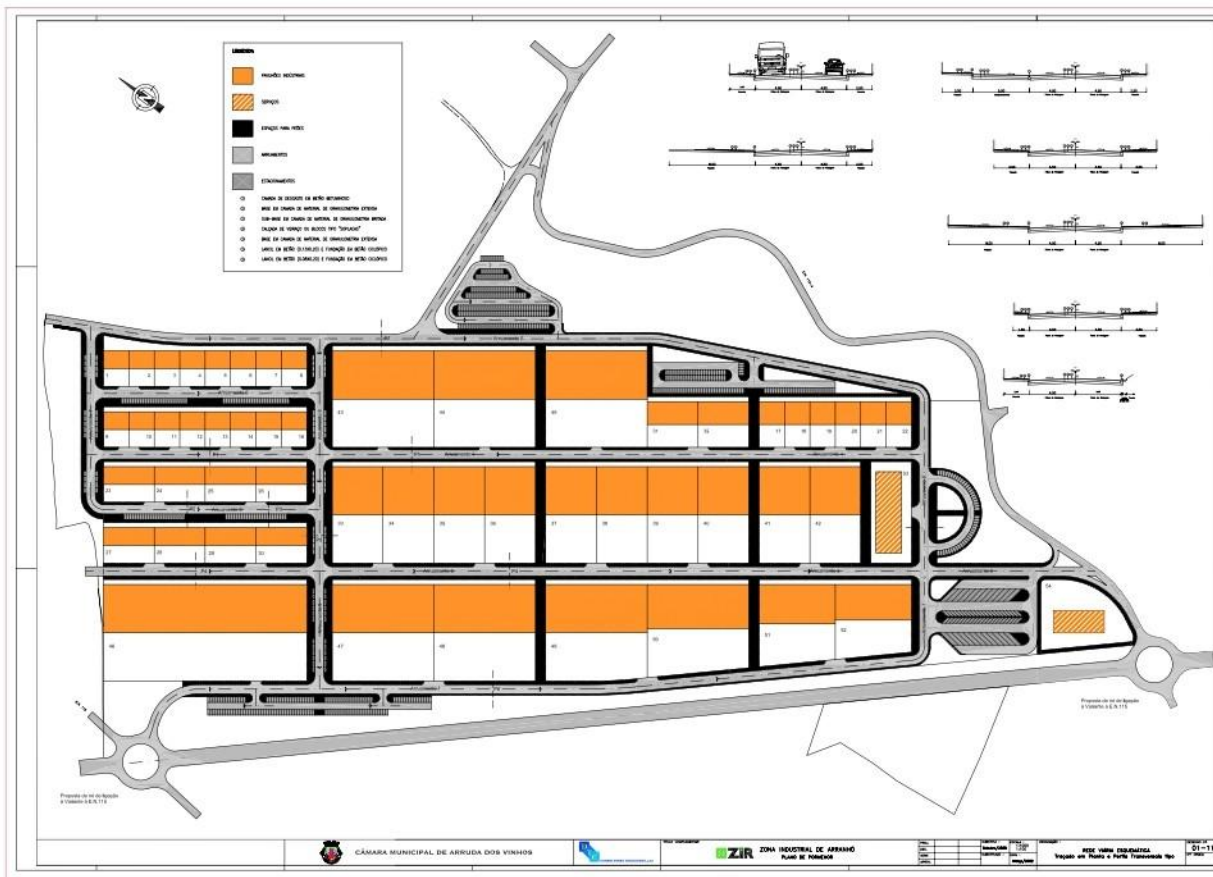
Rede Viária Esquemática - Traçado em planta e perfis transversais tipo
